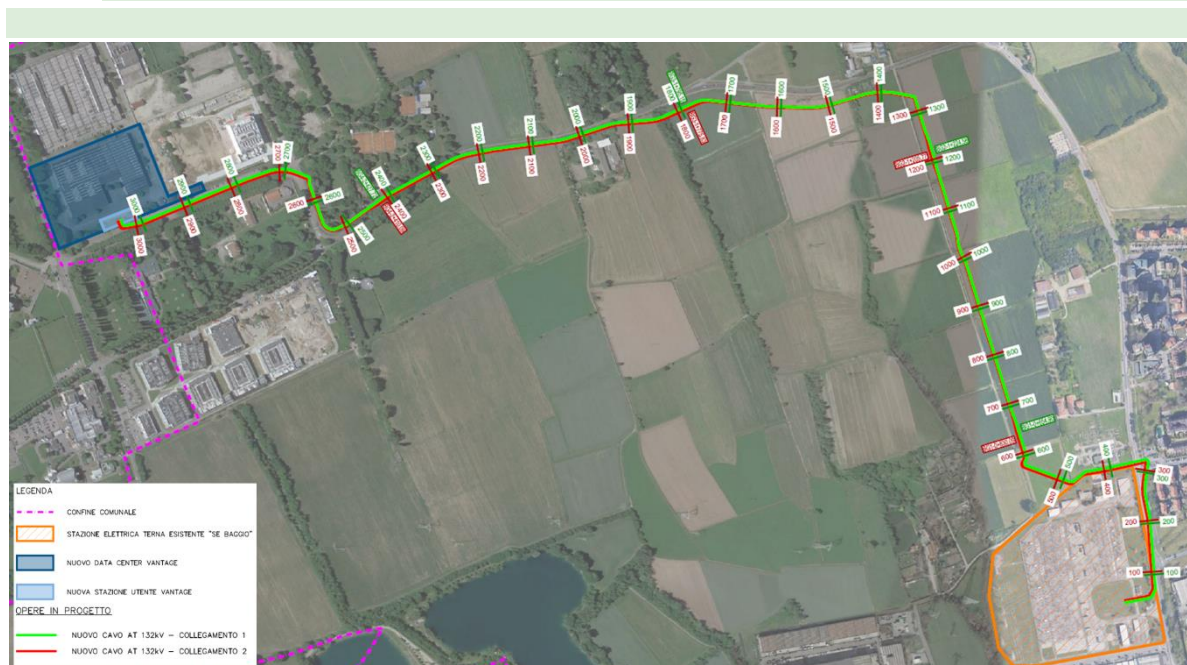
Stralcio della planimetria degli elettrodotti a progetto
